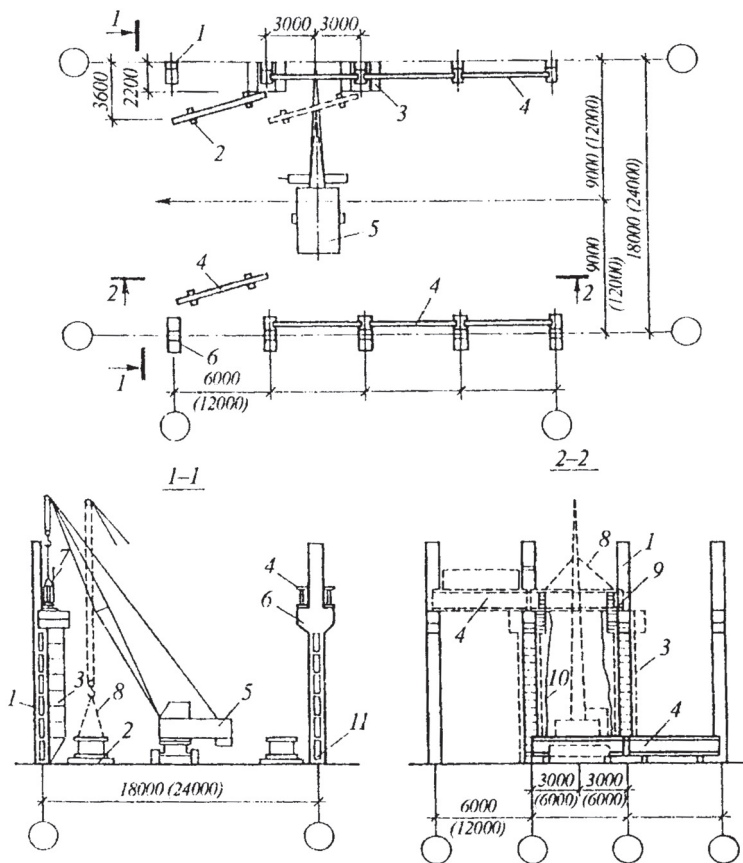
Схема установки подкрановых балок пролетом 6 и 12 м:
